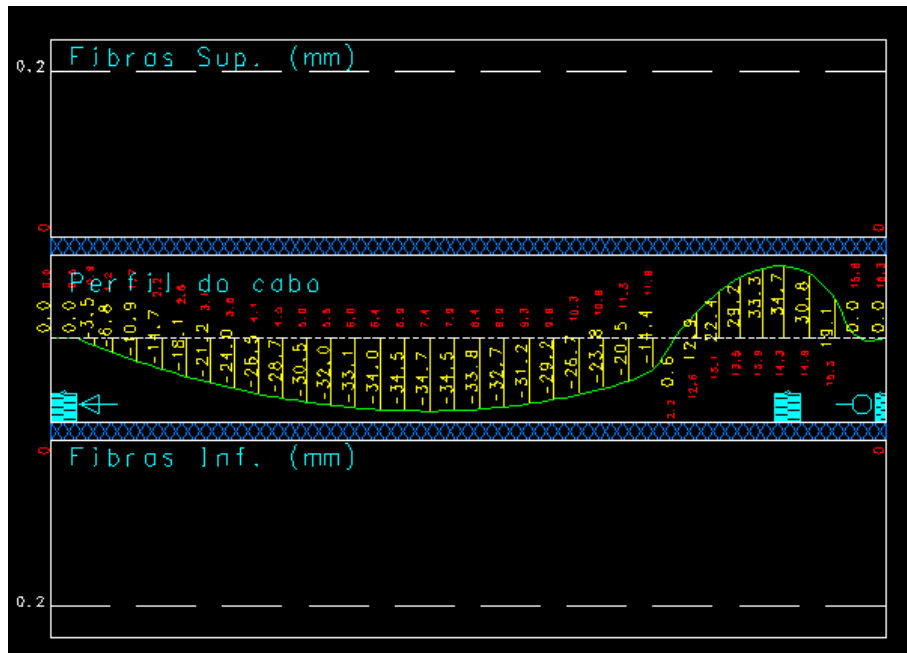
Fissuração viga V9 do subsolo (CAD/TQS)
